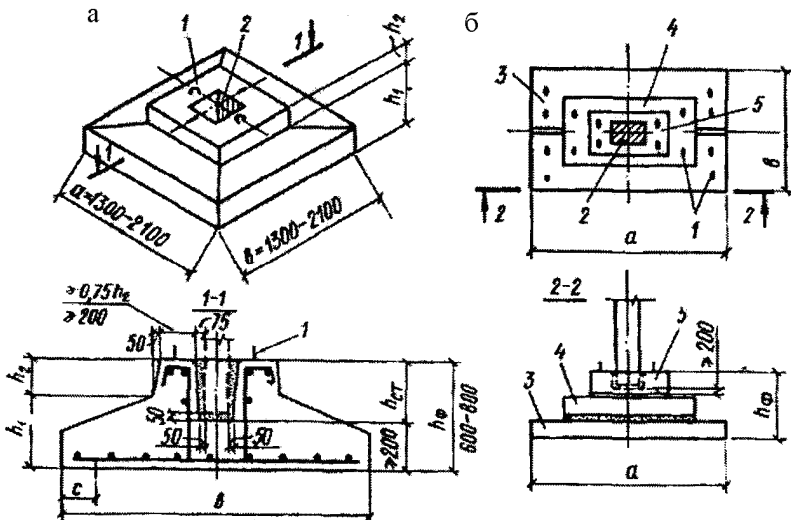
Збірні залізобетонні фундаменти:
